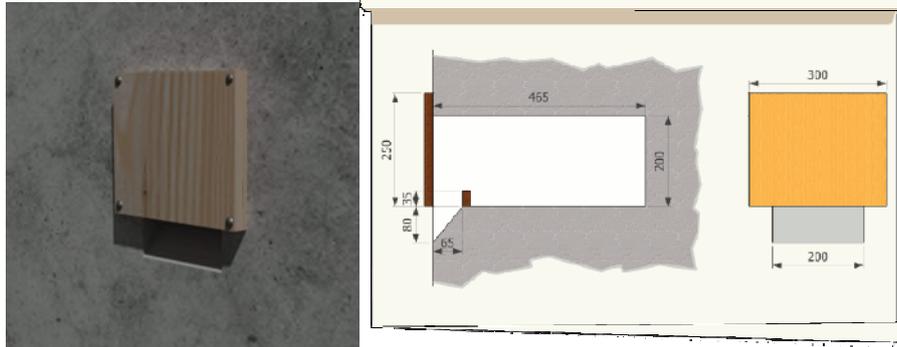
Nichoirs intégrés dans la construction du pont (phot et plan de construction)
